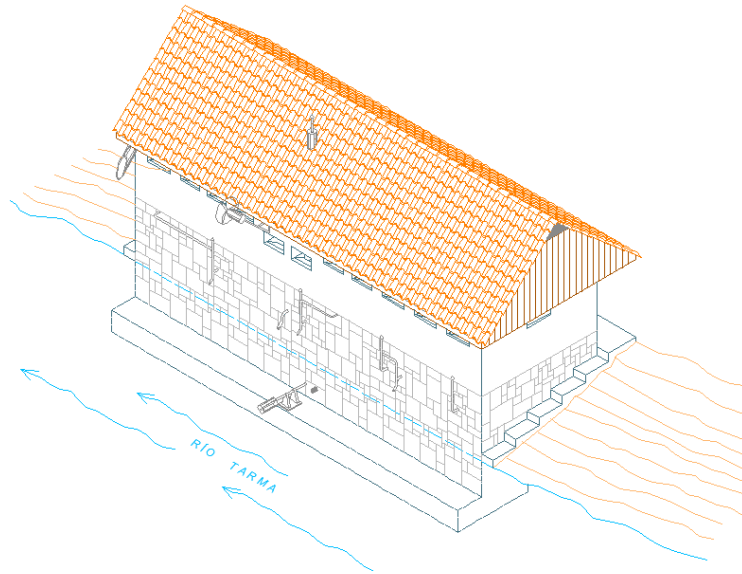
Revestimiento con enlucido de yeso y zócalo perimetral exterior lajas de piedra.
